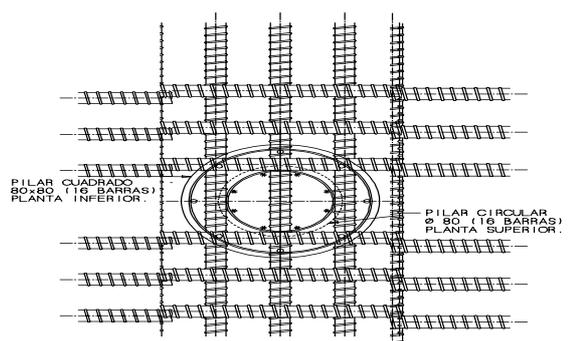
Disposición de armadura en pilares para permitir el paso de las vainas de pretensado.
